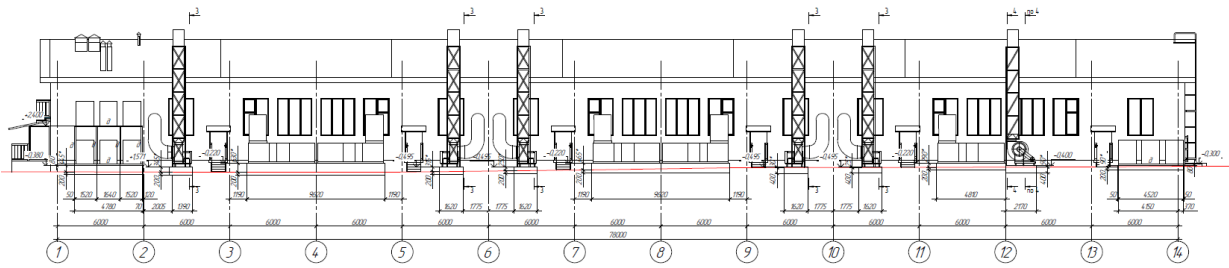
Схема розміщення вентиляційних установок вздовж фасаду 1-14
